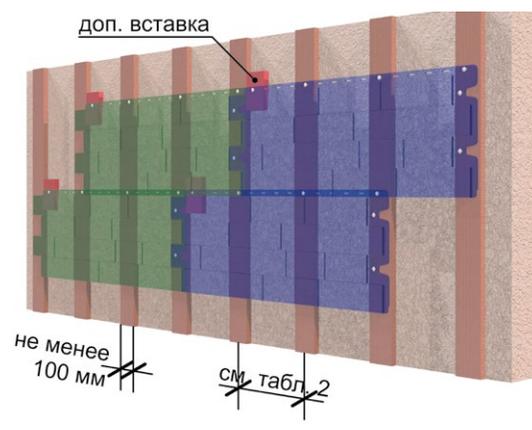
Вертикальная обрешётка под фасадные панели Döcke STEIN и АЛТАЙ
